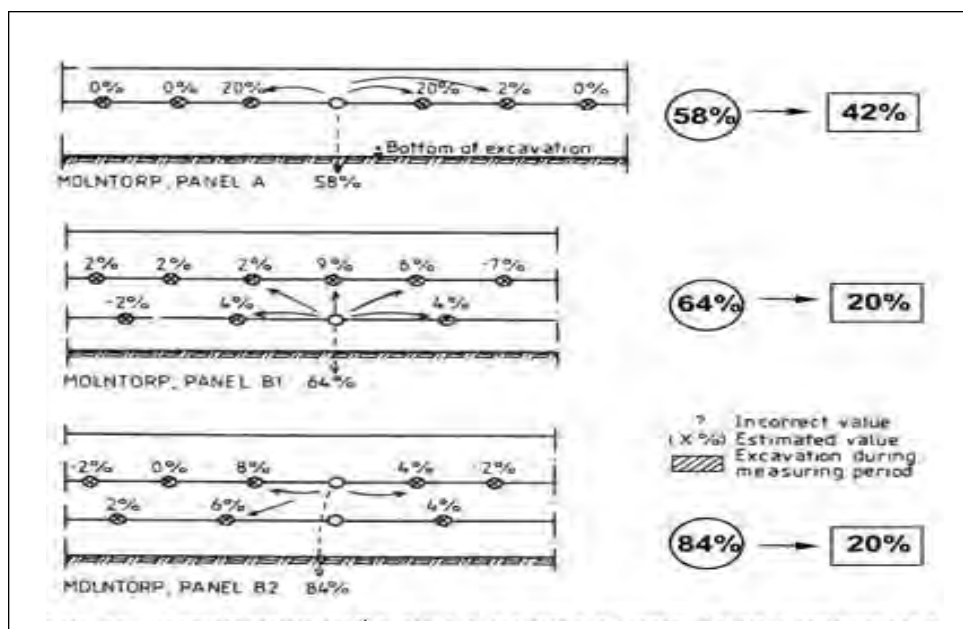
REDISTRIBUCIÓN DE LA CARGA ENTRE ANCLAJES TRAS LA ROTURA DE UNO DE ELLOS (Stille, 1976)
